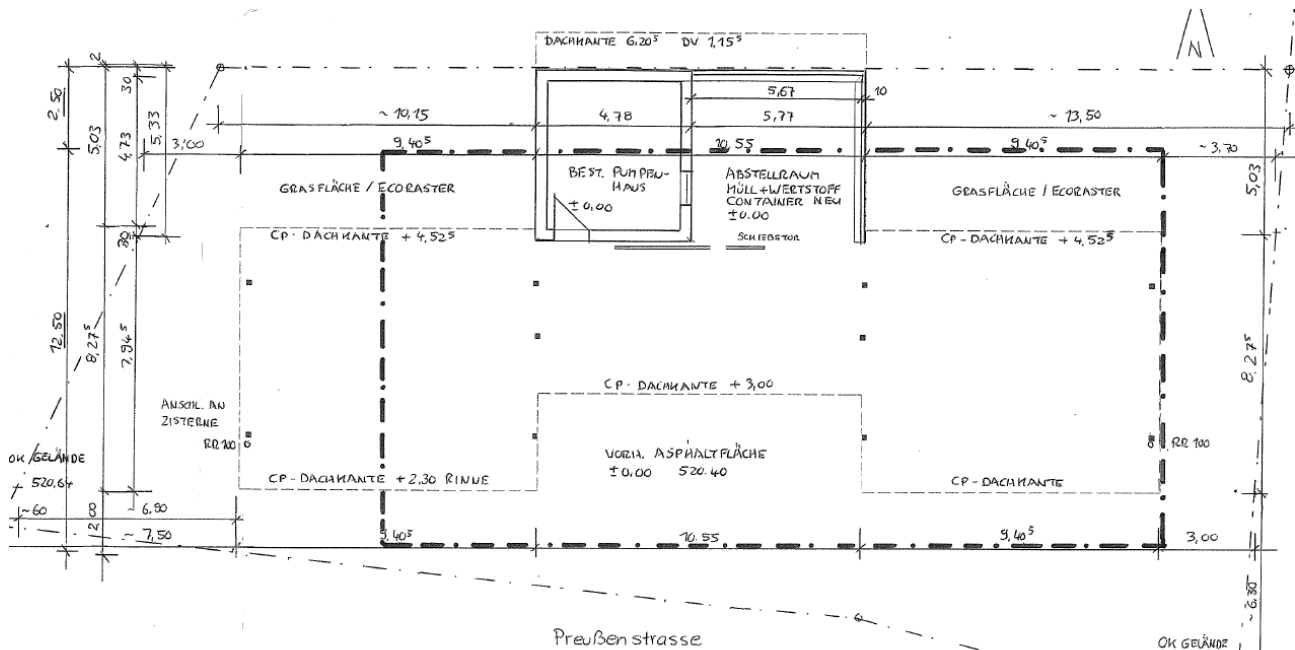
geplante Umgrenzung Carport mit Lage des bestehenden Pumpenhaus
